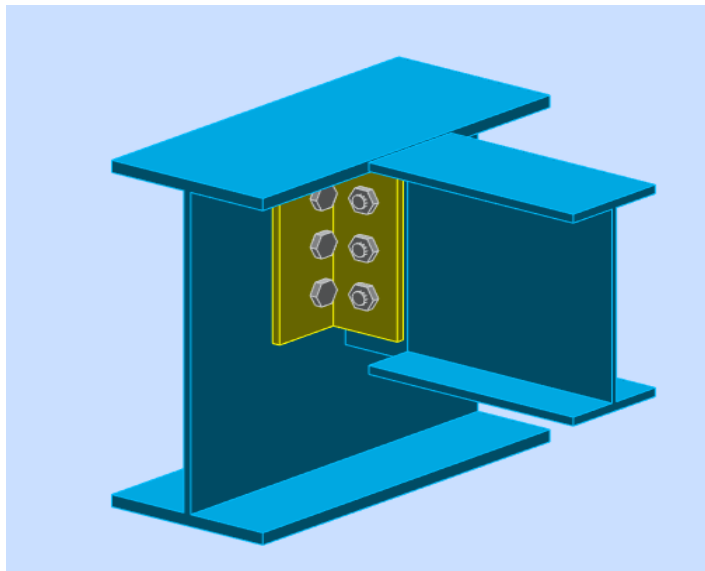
Schéma de l'assemblage poutre – solive.
